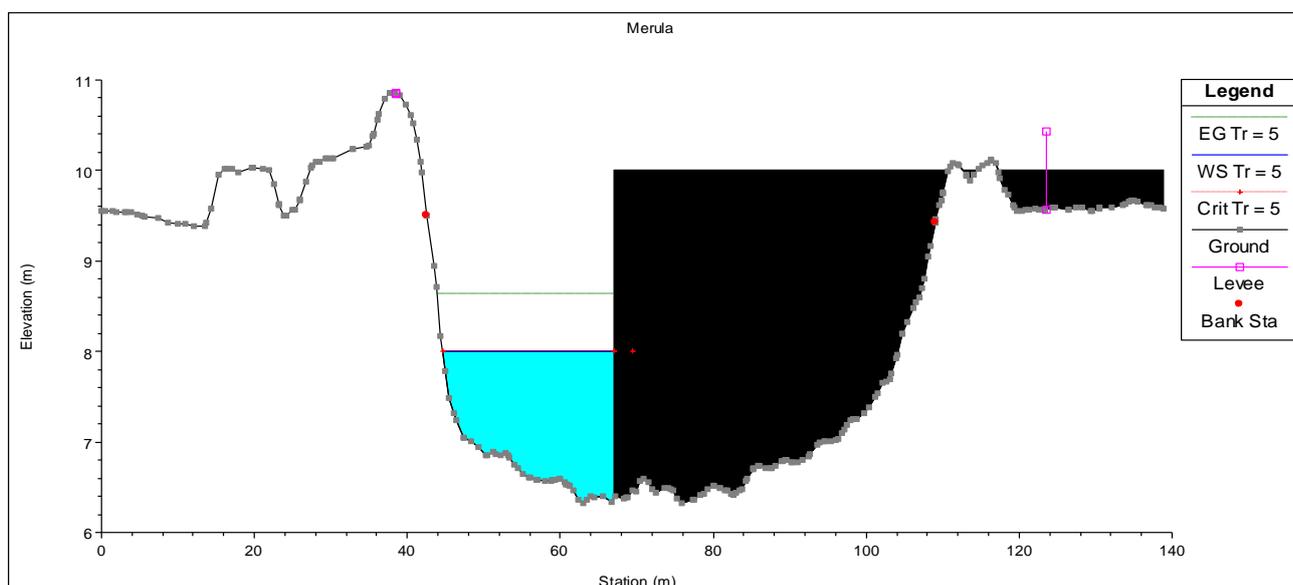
Torrente Merula, realizzazione di pila e spalle del VI08: fase 2
